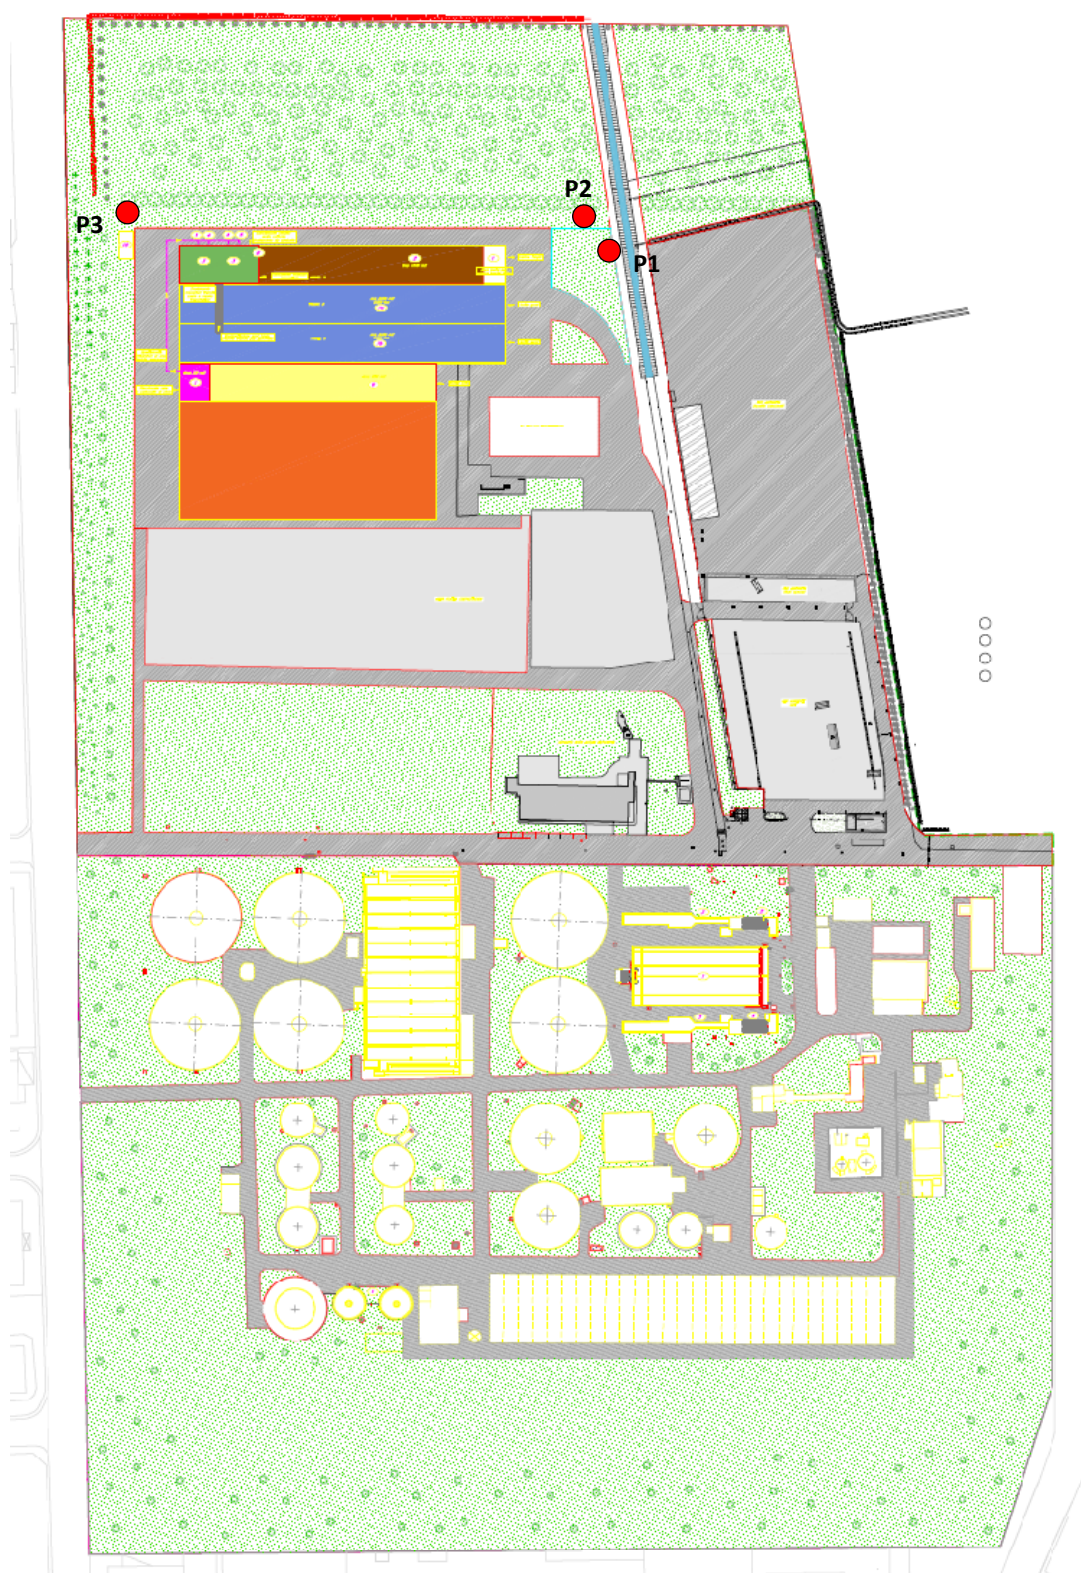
Ubicazione dei punti di campionamento sulla planimetria di progetto dell'opera
